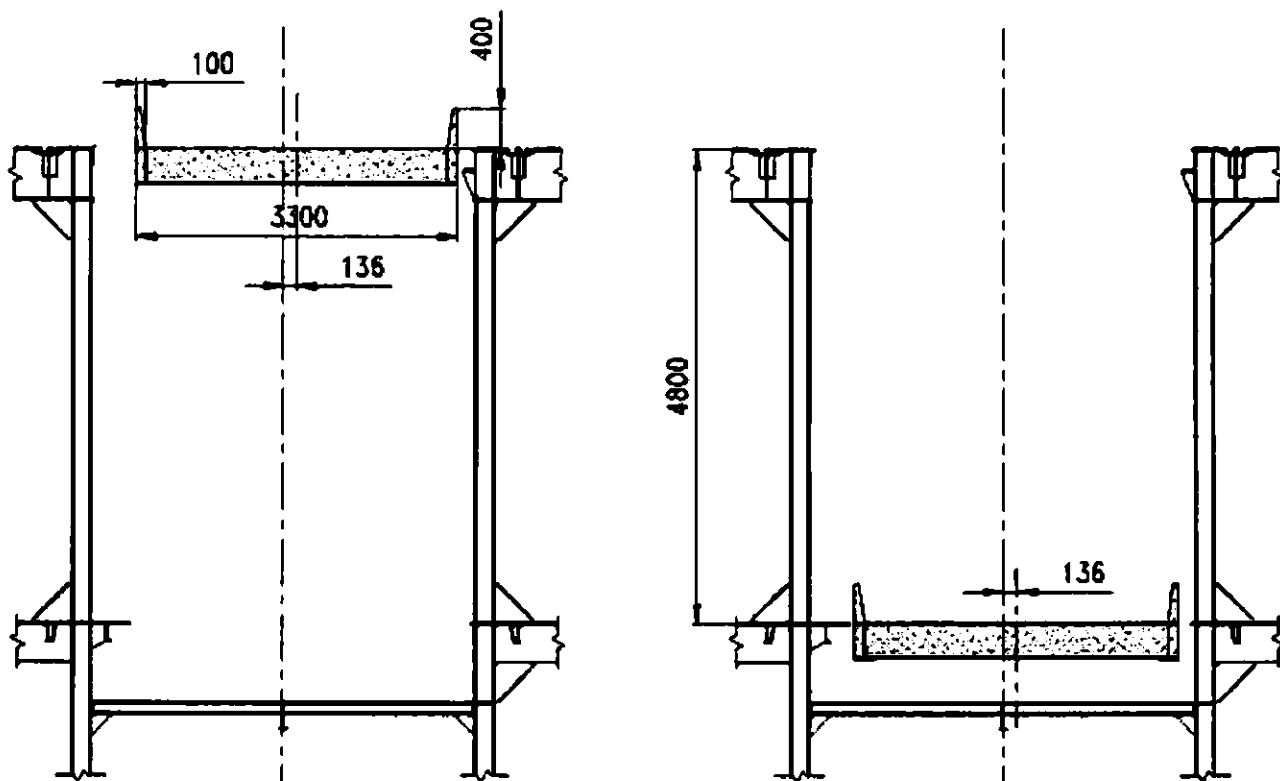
Габаритные размеры поперечный вид / Overall dimensions
